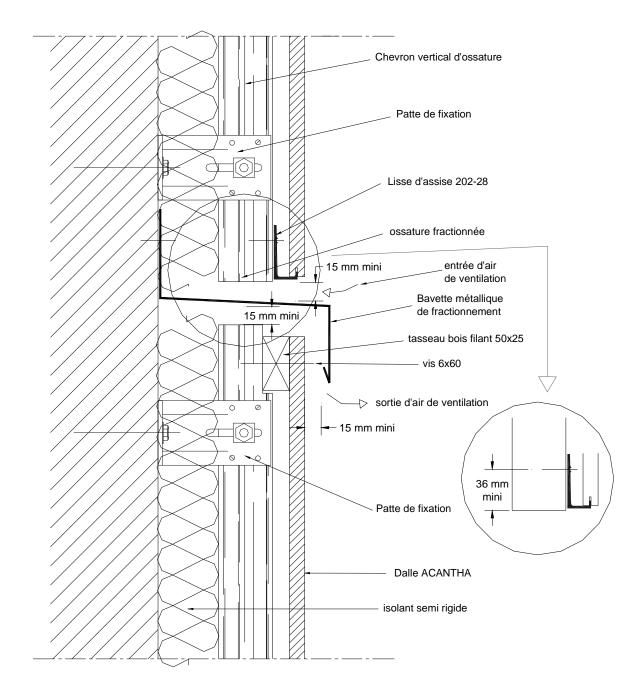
Joint horizontal de fractionnement de la lame d'air (tous les 8 niveaux ou 24 m)
